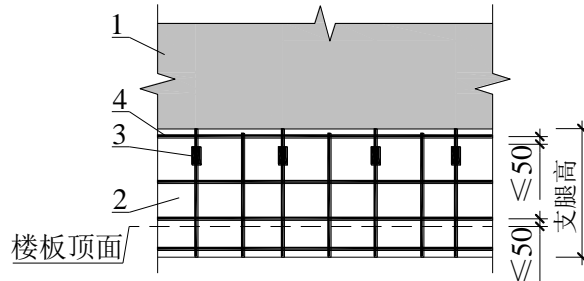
预制剪力墙底后浇段水平钢筋配置示意
